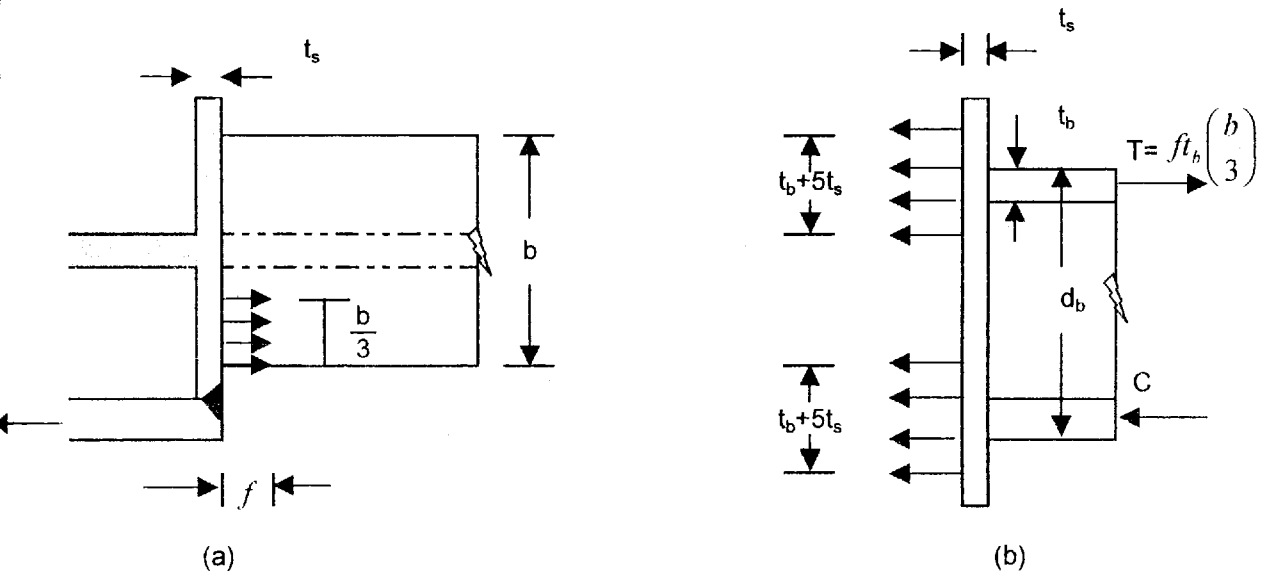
fuerzas llevadas por la soldadura a lo largo de los patines de la T rigidizador.
